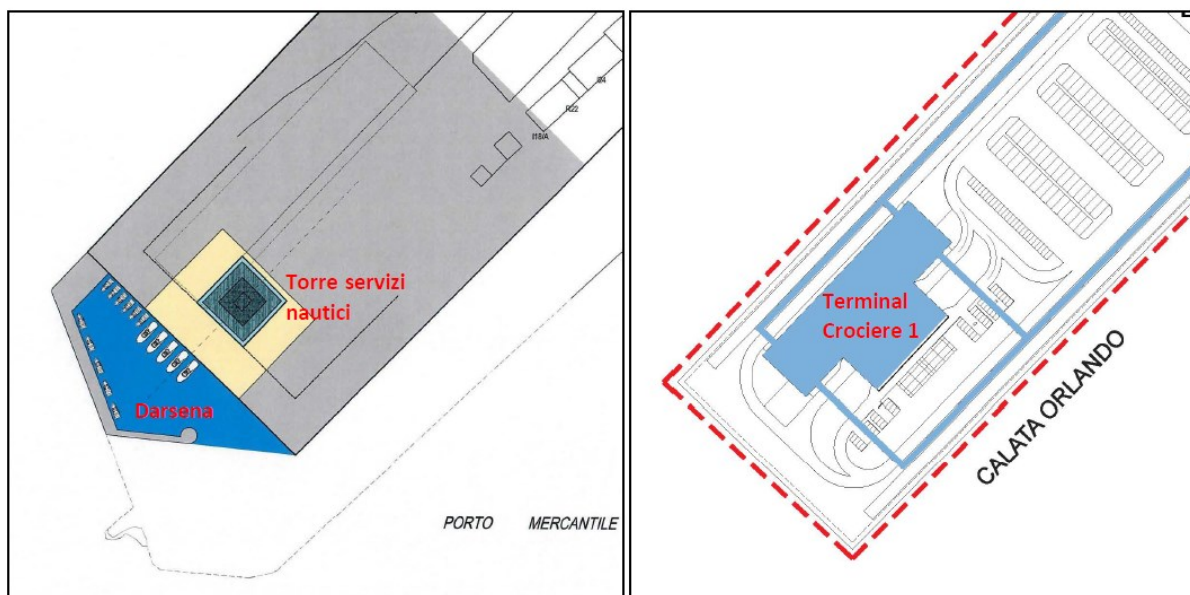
Schema previsionale dell'assetto del Molo Alto Fondale con torre piloti e darsena servizi nautici a sinistra, e configurazione dell'assetto da piano regolatore portuale a destra.
